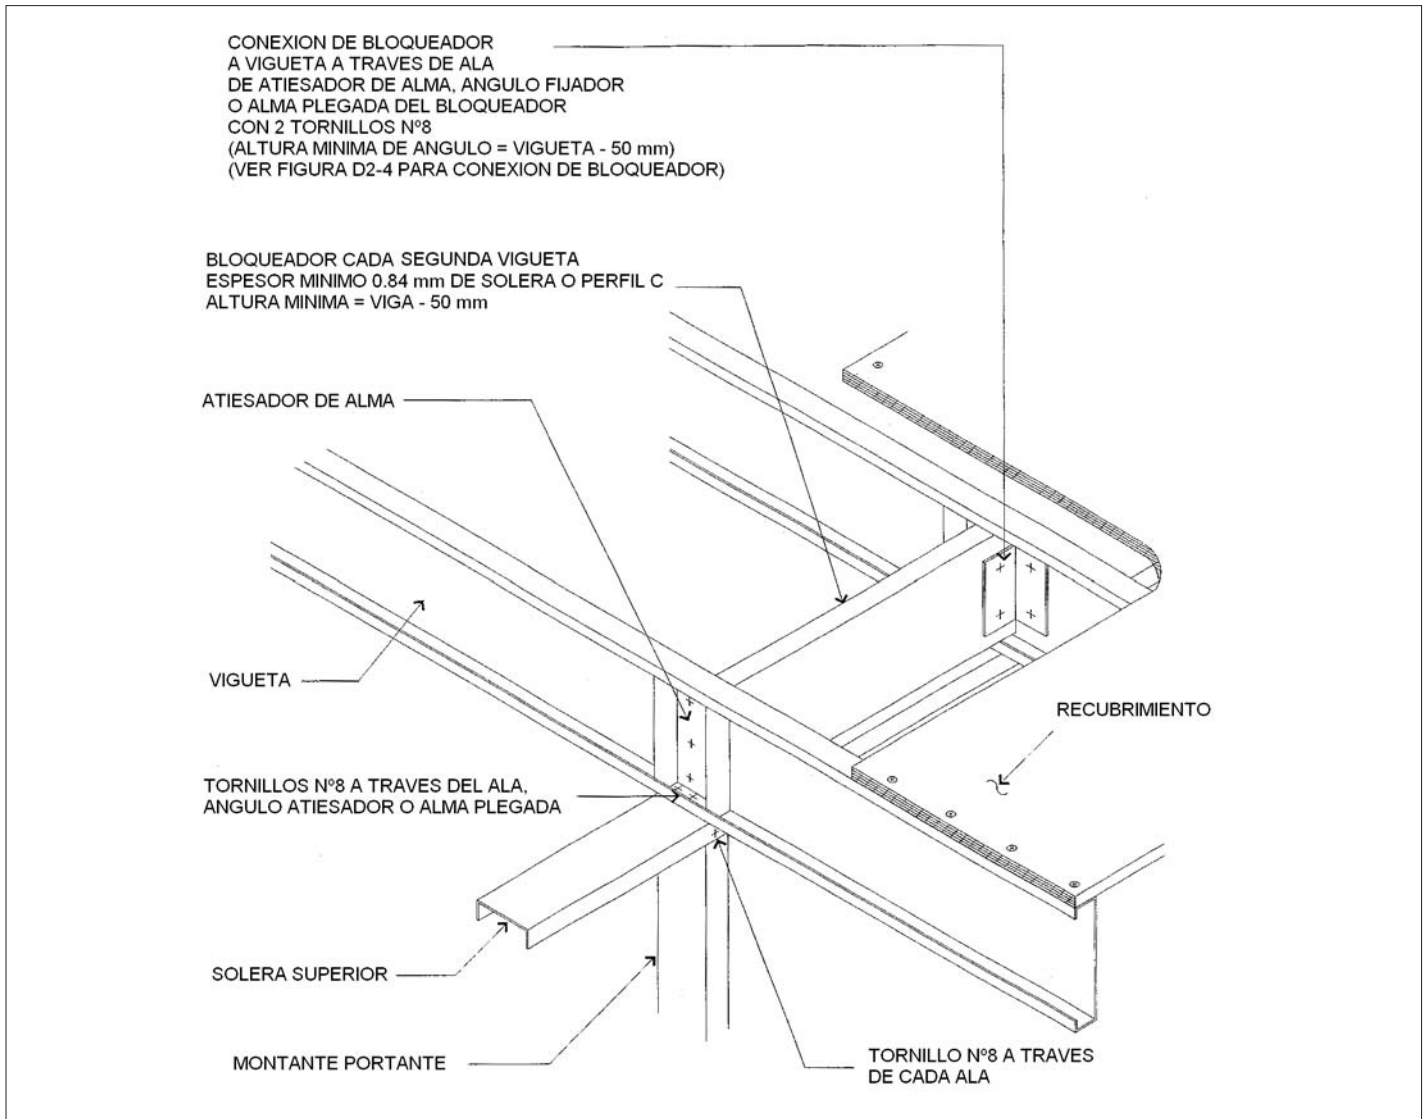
Viga de Piso Continua Apoyada en Muro Portante
